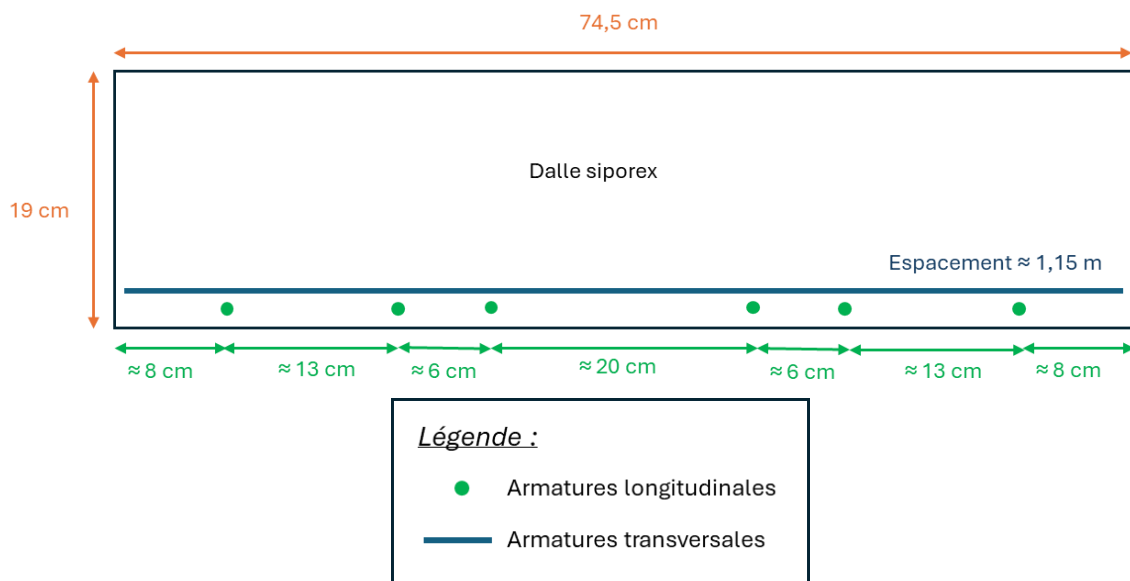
Coupe schématique du principe de ferrailage des dalles portées
